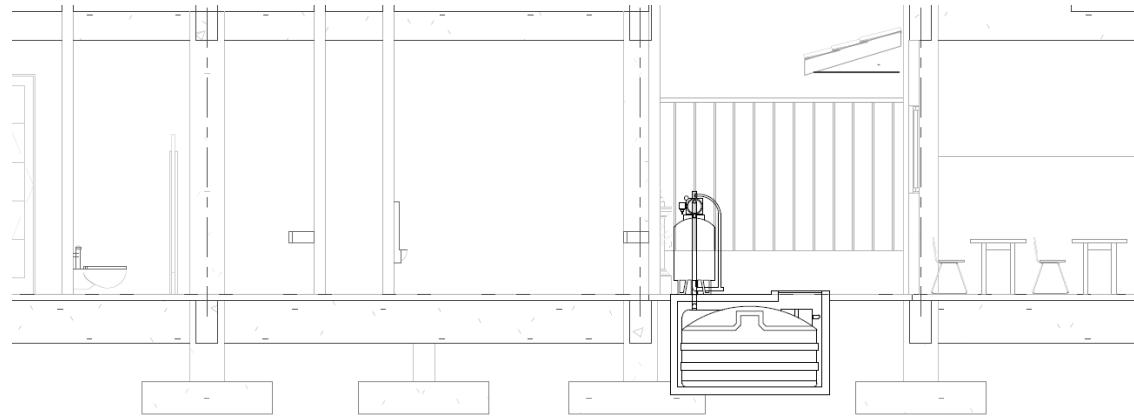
Instalación de Sistema de Captación Pluvial en Corte
